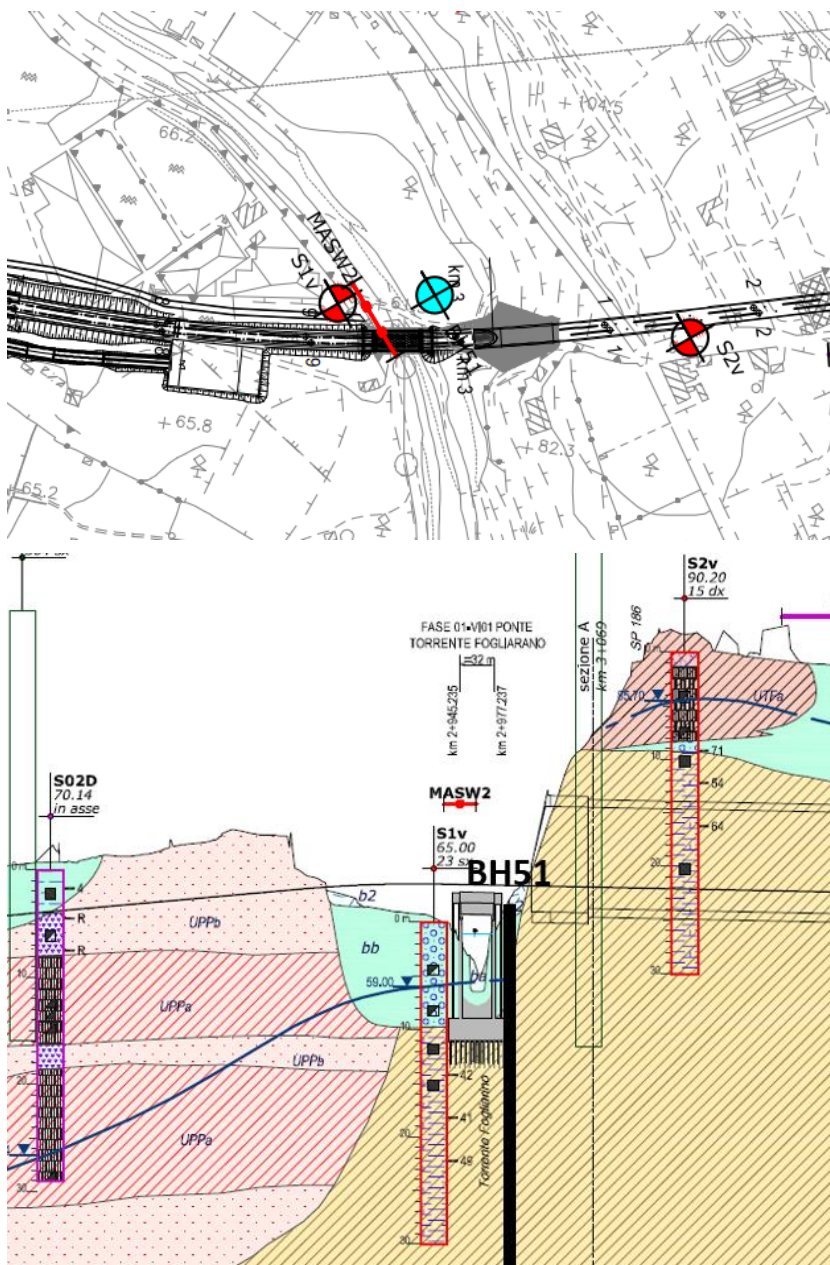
Posizione del sondaggio BH51 in planimetria e profilo
